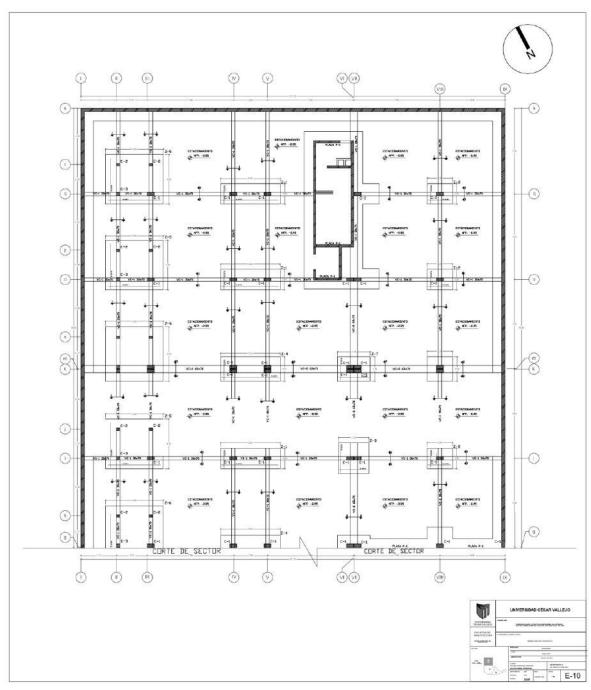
Cimentación - Sector C - ESTRUCTURAS
